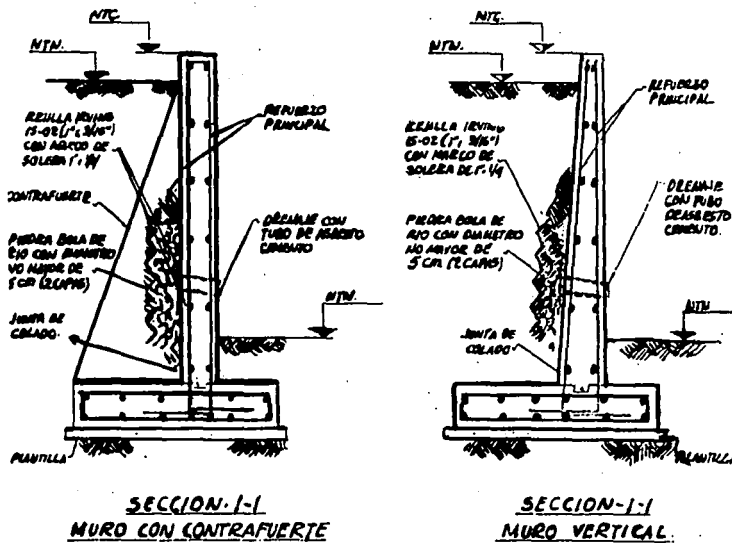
Detalle de armado de un muro de contención, en elevación.
